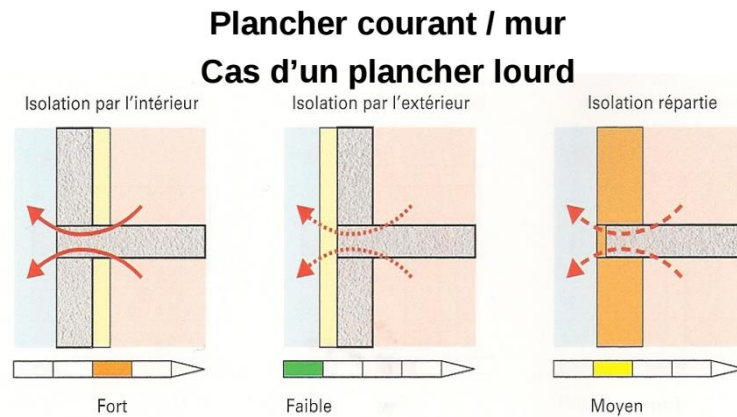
Plancher courant/ mur, cas d'un plancher lourd [3].
